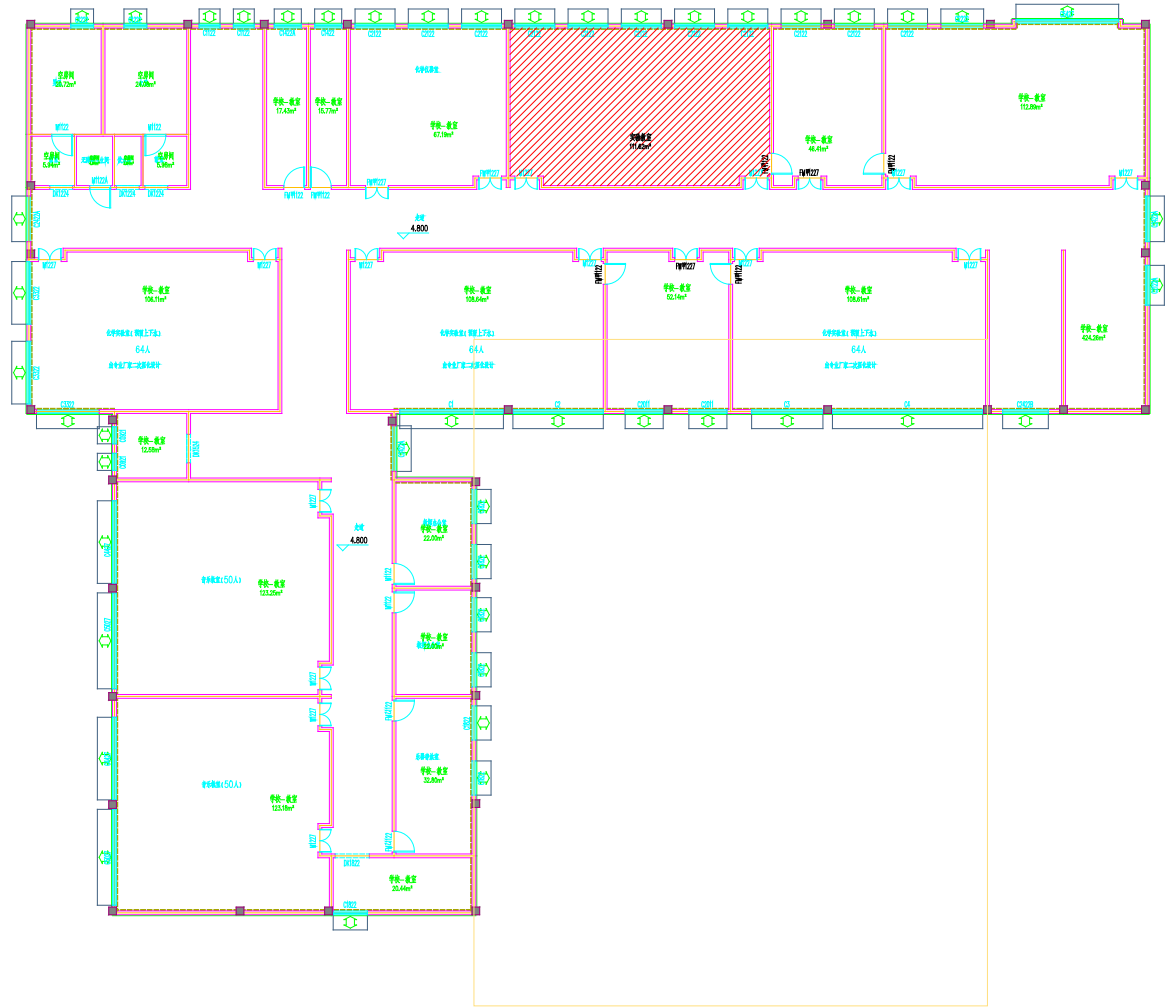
受建筑外部噪声影响的典型房间楼层平面图
